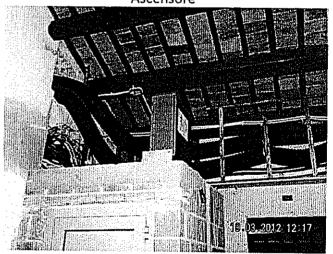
Secondo piano: Ballatoio scale- Vista tetto e impianti meccanici posati
